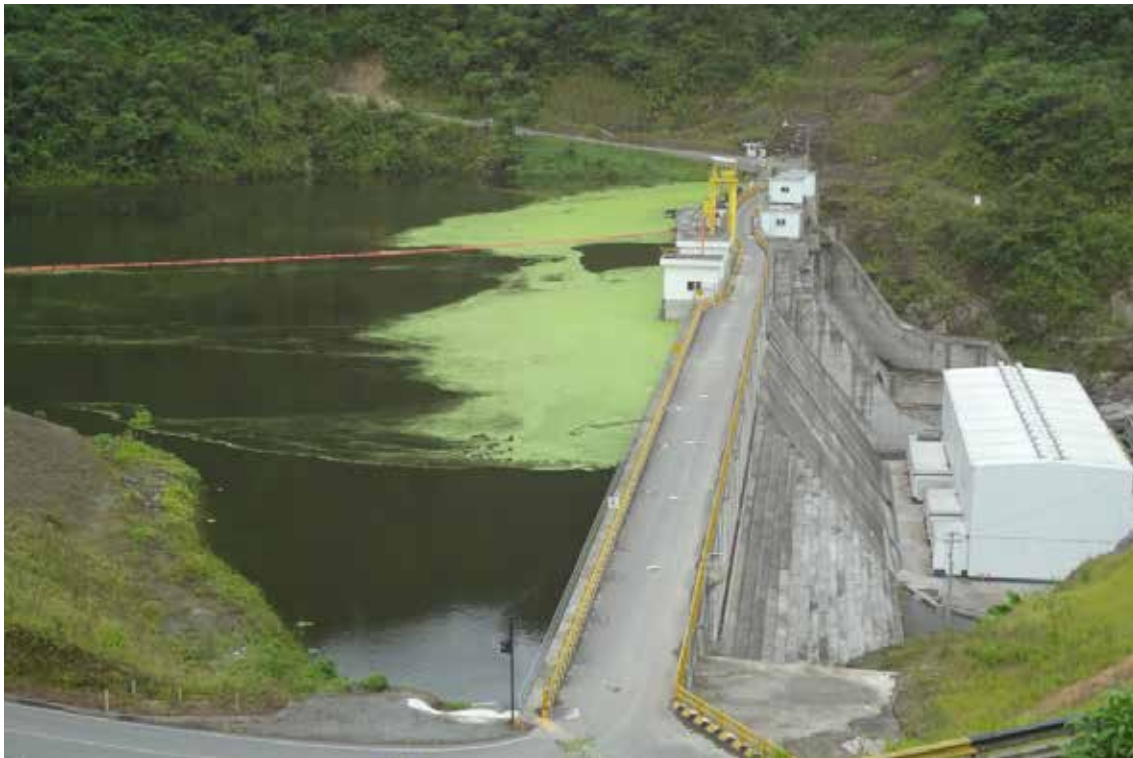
Presa Manduriacu a gravedad de hormigón rodillado y vibrado
